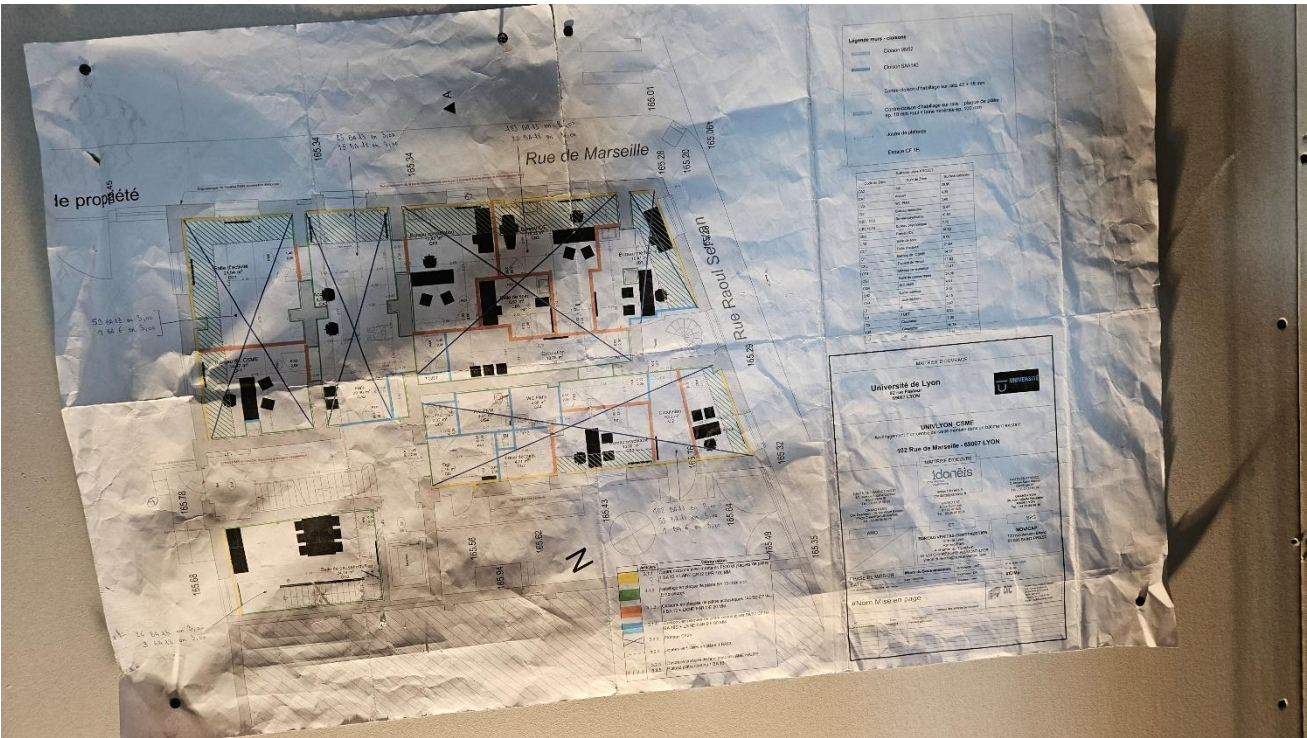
Plans d'aménagement projeté du RDC du bâtiment
